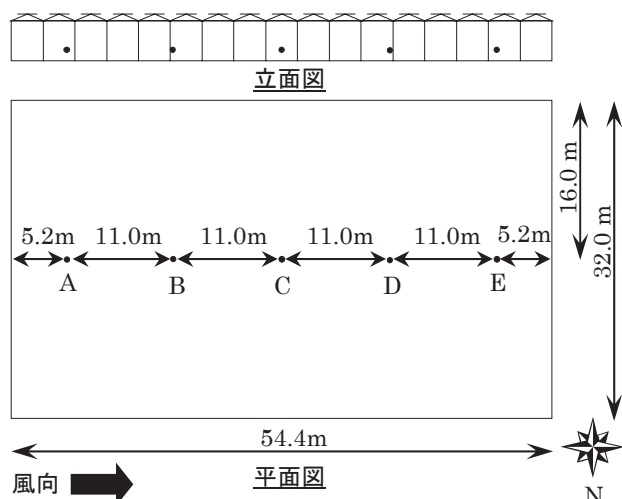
17連棟のフェンロー型温室の平面・立面図および測定点(●)の配置
